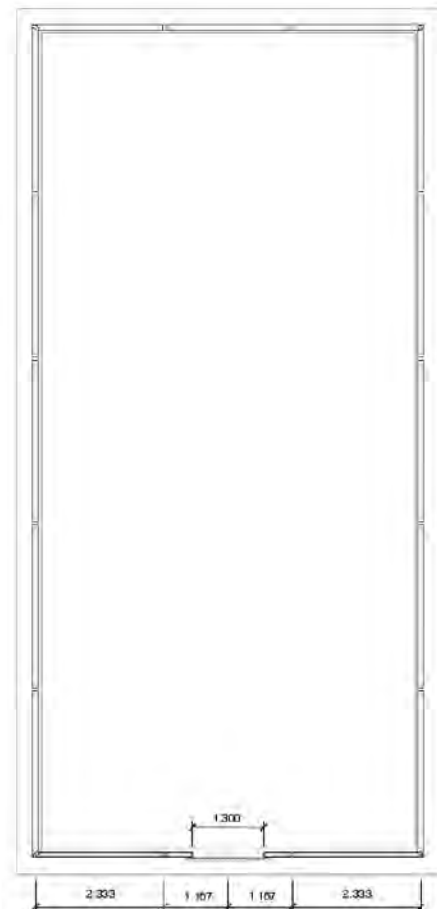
Planta y alzado del módulo de invernadero de 6 x 30 metros cada uno, se proponen 20 de ellos para una producción de 25,000 plantas CRJ MADMP 03
